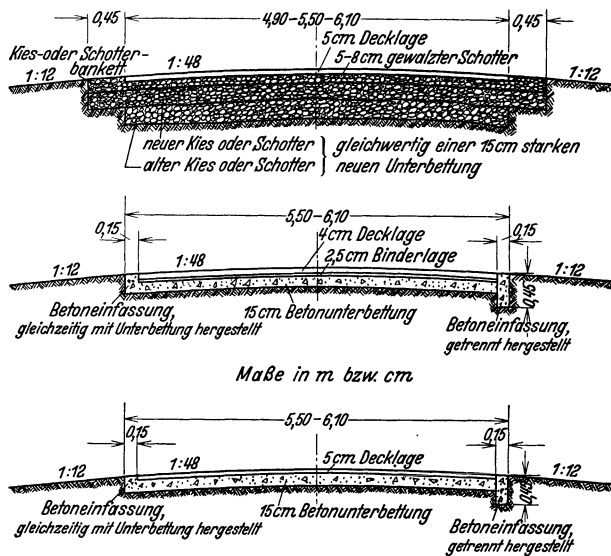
Regelquerschnitte des Bureau of Public Roads für Asphaltbeton (asphaltic concrete) [E 4].
